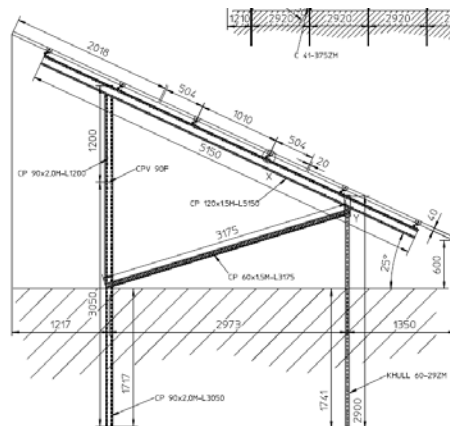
Vorgesehenes Design des PV-Tisches mit entsprechenden Rammprofilen
